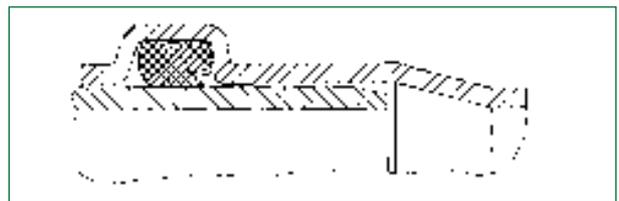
Steckmuffenverbindung für außen glatte Rohre
